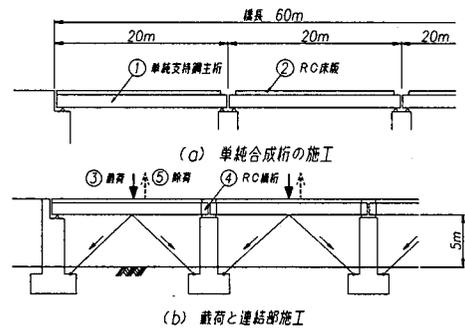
ワイヤー緊張法の施工手順図(橋長 60m の場合)
